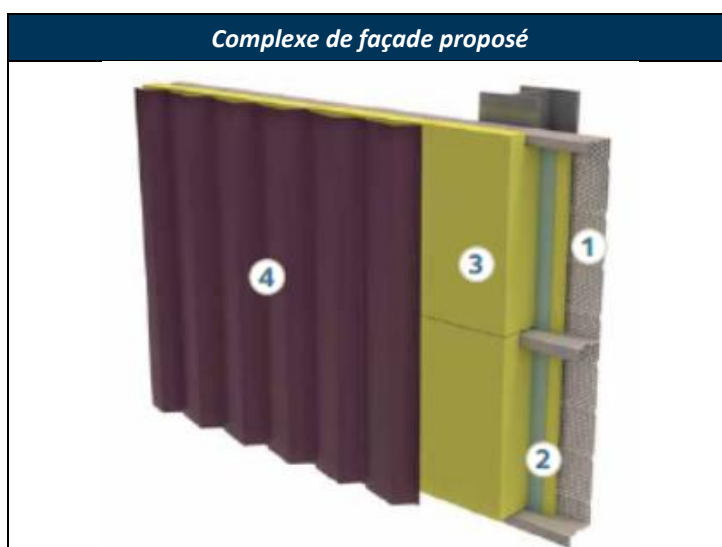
Complexé de façade proposé pour la création d'un bâtiment technique ELOGEN
